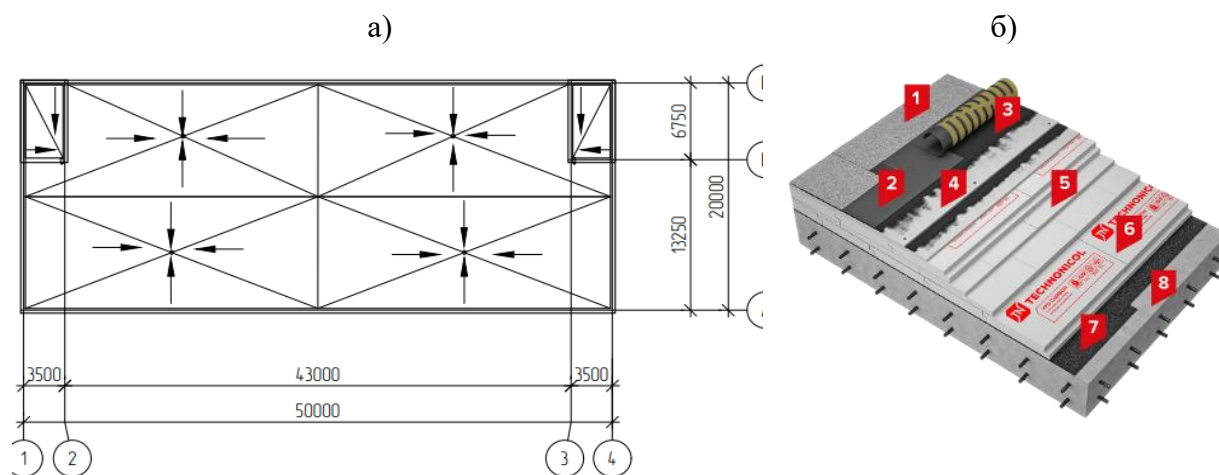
Битумно-полимерная крыша: а) план крыши; б) состав кровельного пирога: 1, 2 – гидроизоляция битумно-полимерная; 3 – битумный праймер; 4 – стяжка из 2 слоев хризотилцементных листов; 5 – уклонообразующий слой – экструзионный пенополистирол; 6 – теплоизолирующий слой – экструзионный пенополистирол; 7 – пароизоляция; 8 – железобетонная плита
